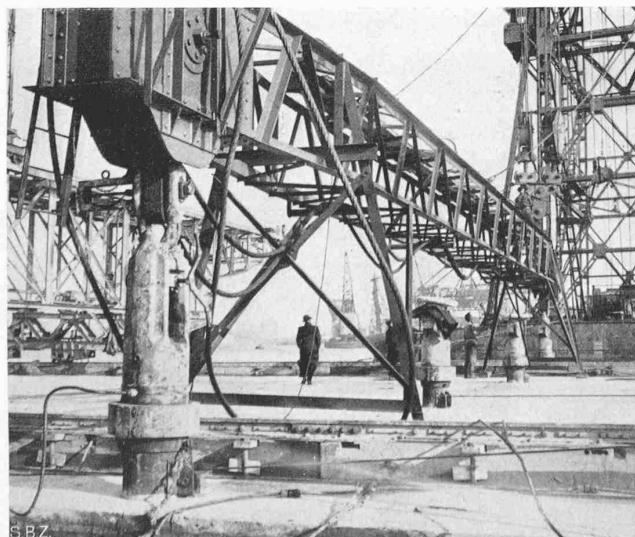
Aufhängung mittels Waagebalken. Bei der Pendelsäulen-Pressen im Vordergrund ist die Ölzuleitung erkennbar
